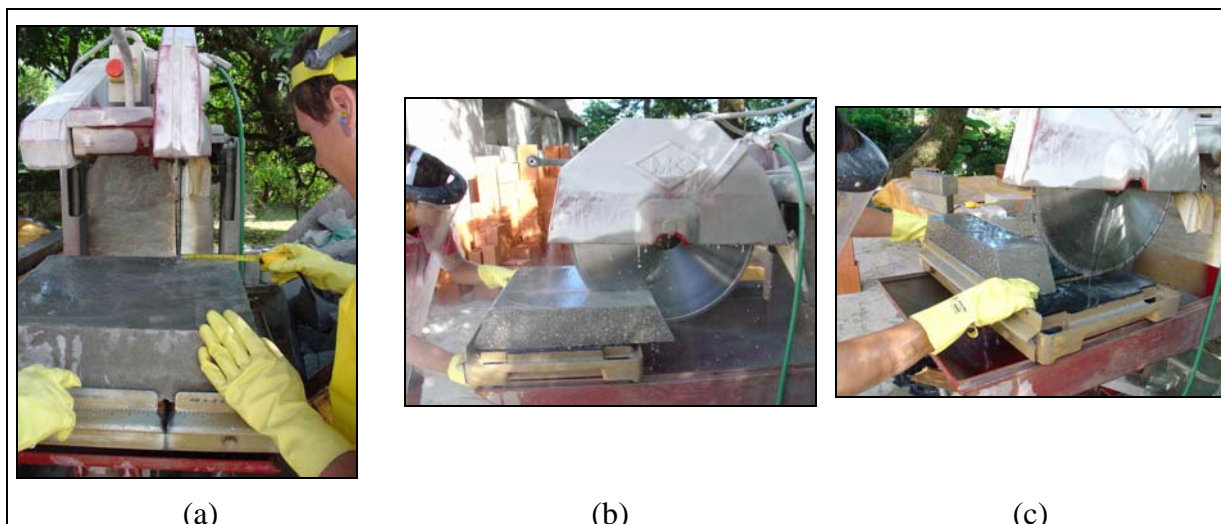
Corte na placa de concreto utilizando a serra do laboratório: (a) marcação da largura da viga; (b) corte longitudinal; (c) retirada da lateral inclinada, definindo o comprimento da viga.
